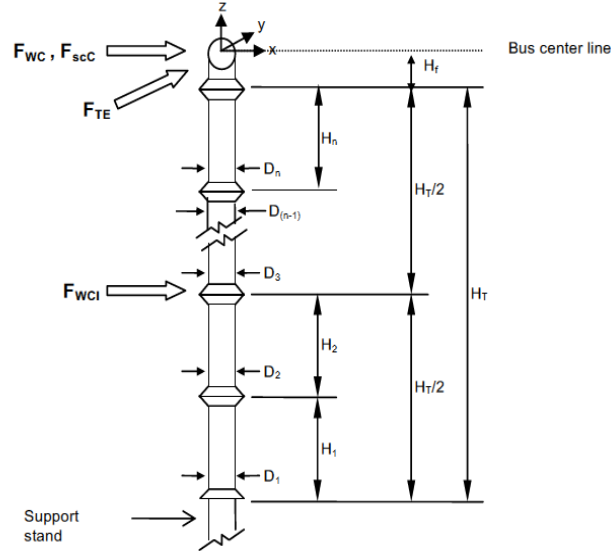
Cargas sobre un aislador montado verticalmente (IEEE Std 605-2008)
